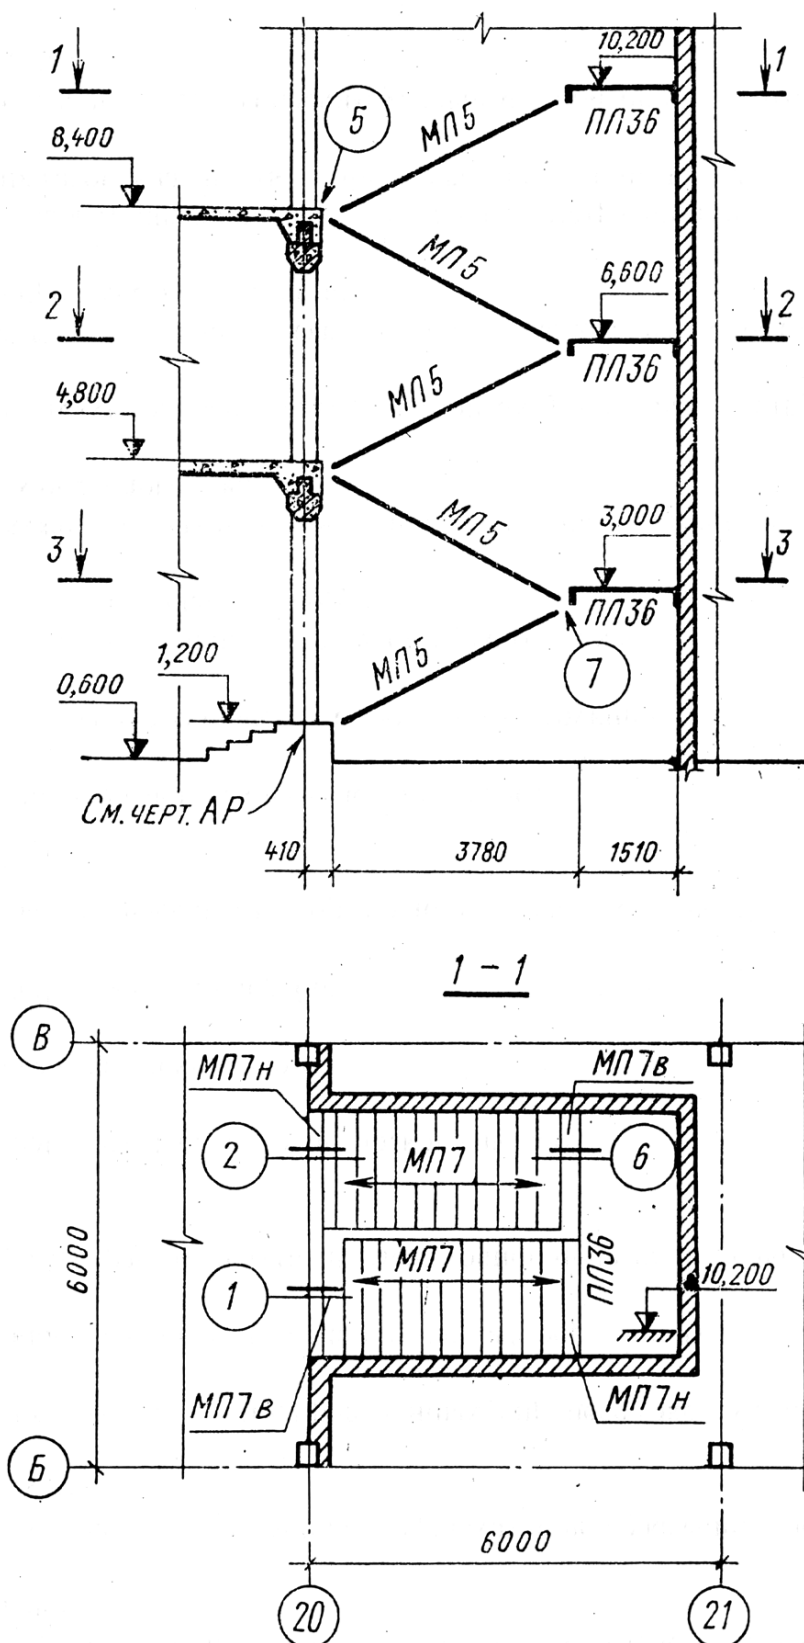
Маркировочная схема элементов лестницы между осями 20-21
